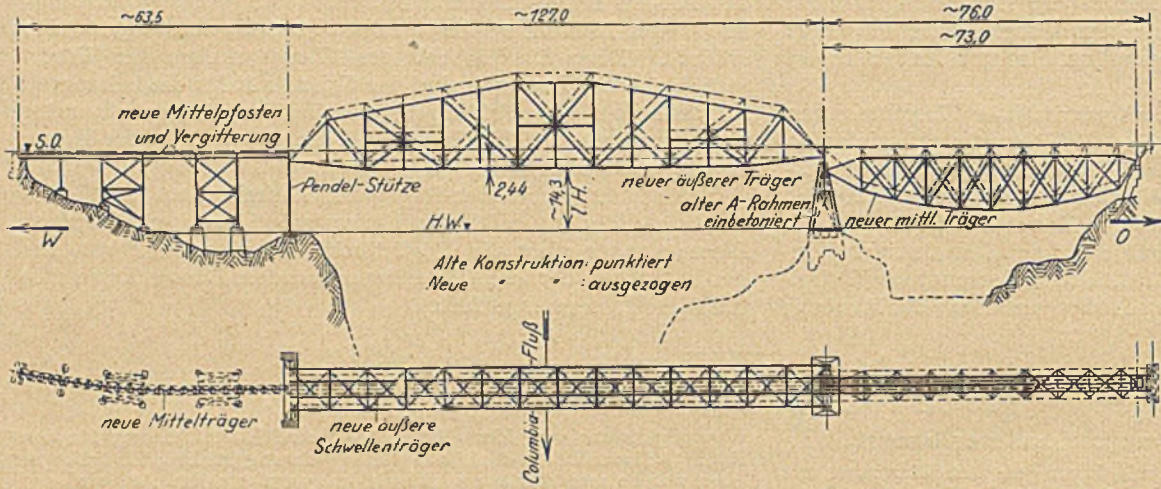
Grund und Aufriss der verstärkten Brücke.
